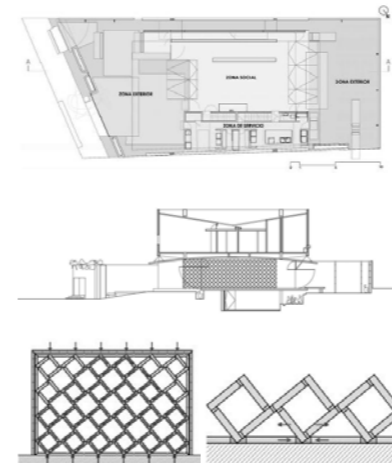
Planta, Corte y Cerramiento Casa Abu Fontz / Fuente:Análisis de las Características Estructurales en la Obra del Gabinete de Arquitectura y Propuesta Arquitectónica
